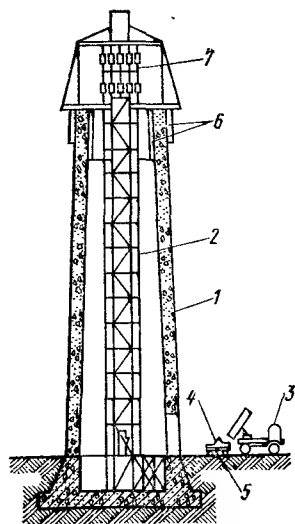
Подача бетонной смеси шахтным подъемником:
